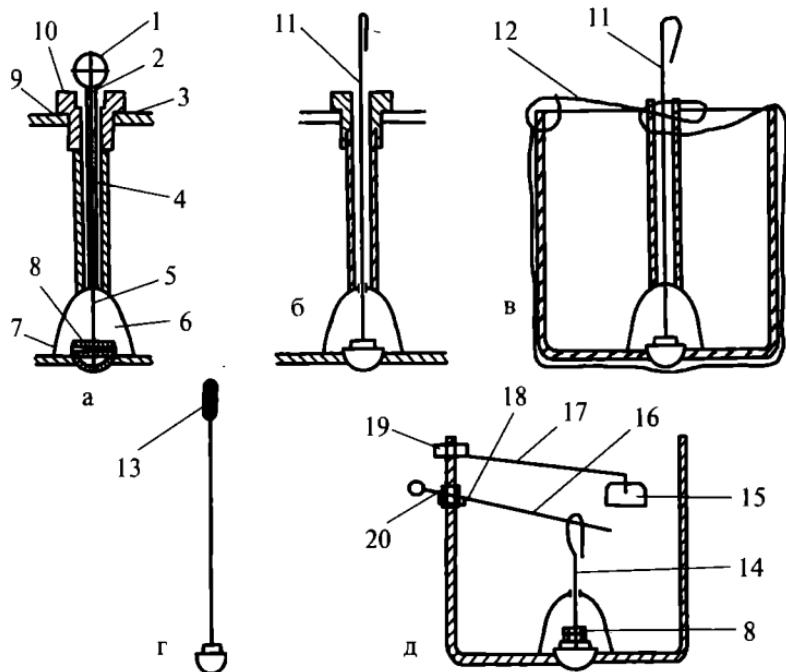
Спускные механизмы сливных бачков: а — верхний спускной стандартный механизм; б — верхний спускной дозирующий механизм при стандартной или самодельной крышке сливного бачка; в — верхний спускной дозирующий механизм при отсутствии крышки; г — удлиненная тяга с самодельной отделяемой рукояткой для верхнего спускного механизма; д — боковой спускной дозирующий механизм; 1 — рукоятка; 2 — тянувшая трубка; 3 — крышка бачка; 4 — направляющая трубка; 5 — короткая тяга; 6 — груша; 7 — дуга; 8 — груз; 9 — прокладка; 10 — специальная втулка; 11 — удлиненная тяга; 12 — проволока; 13 — самодельная рукоятка; 14 — тяга с загибом; 15 — поплавок; 16 — спускной рычаг; 17 — рычаг поплавочного клапана; 18 — винты; 19 — поплавковый клапан в сборе; 20 — пластины крепления
